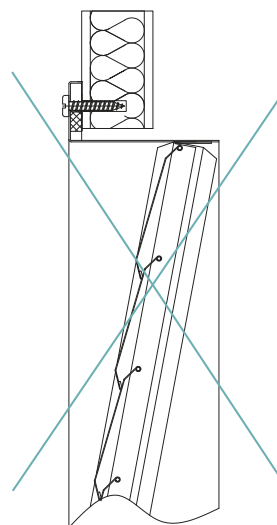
Montaż w ścianie murowanej lub betonowej.
